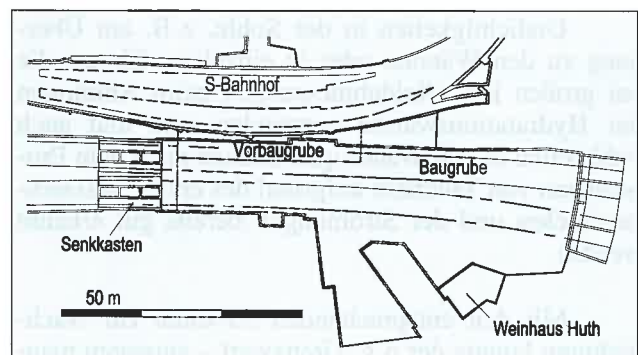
Grundriß Gemeinsame Baugrube Potsdamer Platz und bestehender S-Bahnhof
